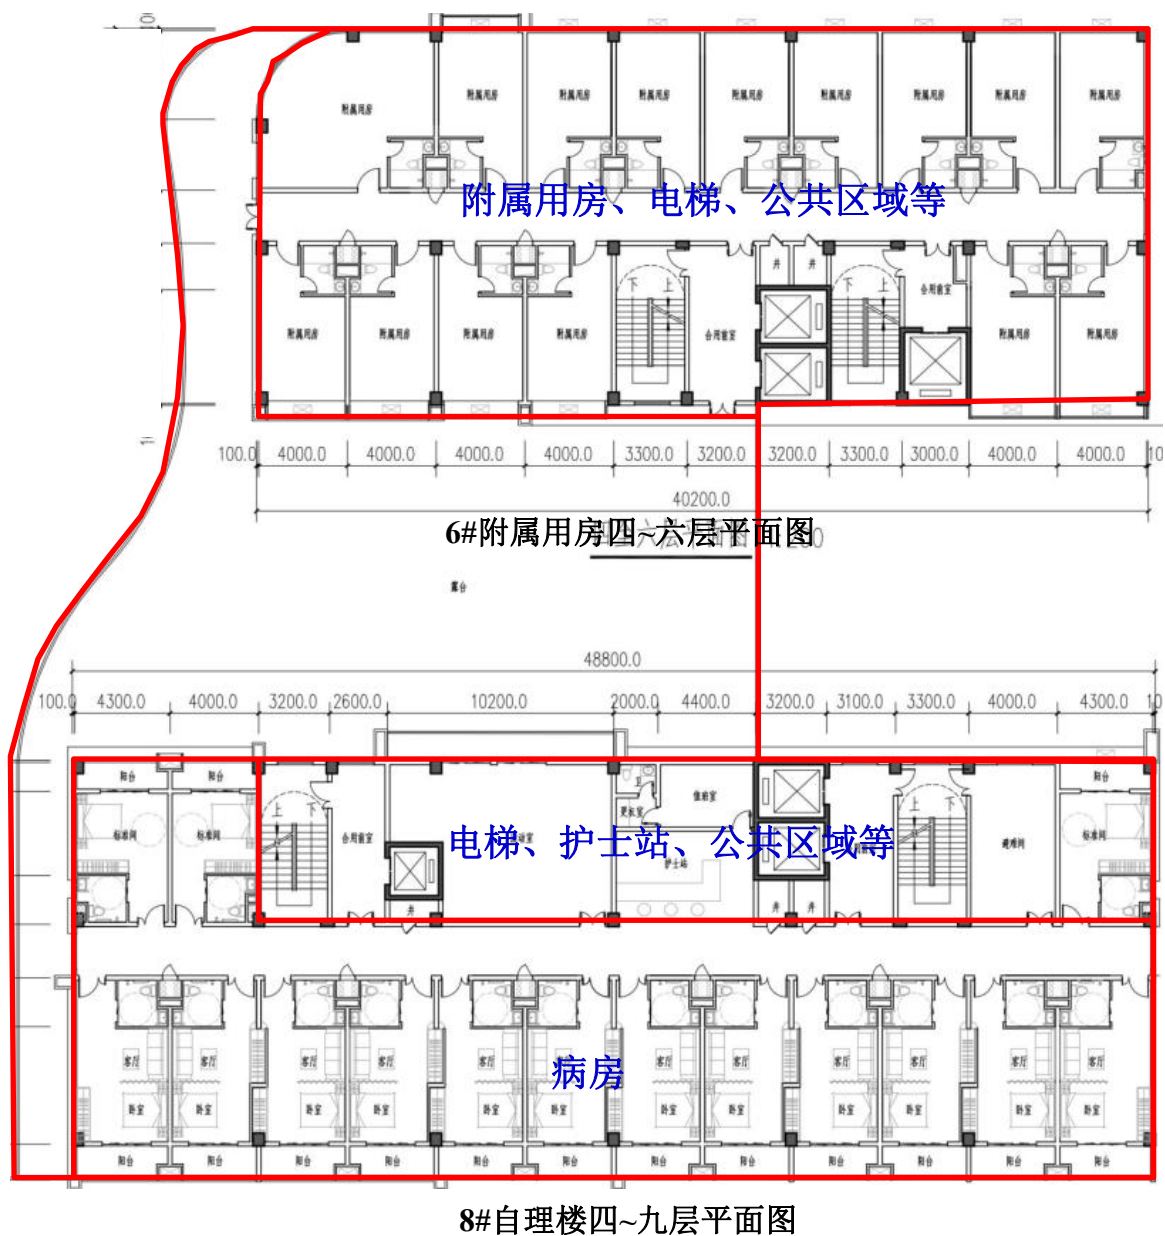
6#附属用房、8#自理楼其余楼层平面图
